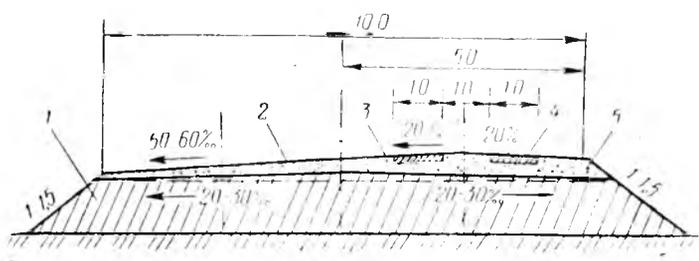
Специальный поперечный профиль двухполосной дороги с колеиным железобетонным покрытием:
